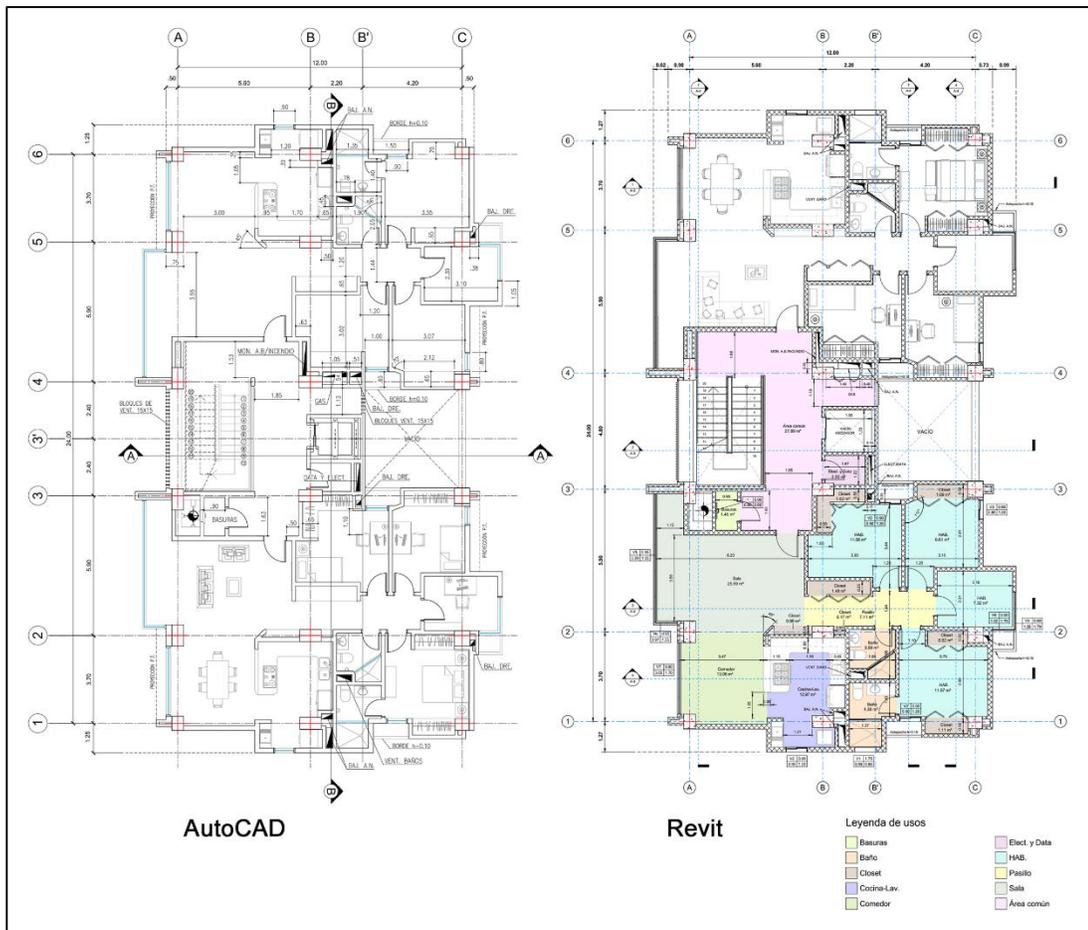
Comparación de plantas realizadas en AutoCAD y aquellas con Revit.
